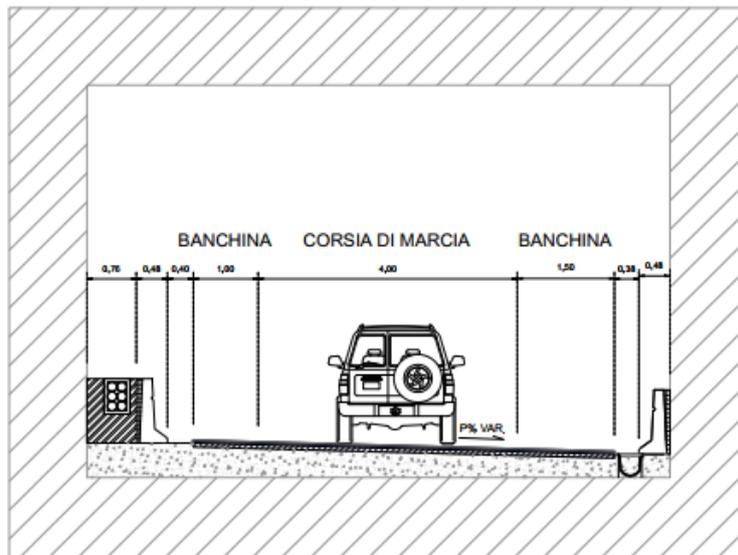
Sezione Tipo monolite esistente per il ramo 1
